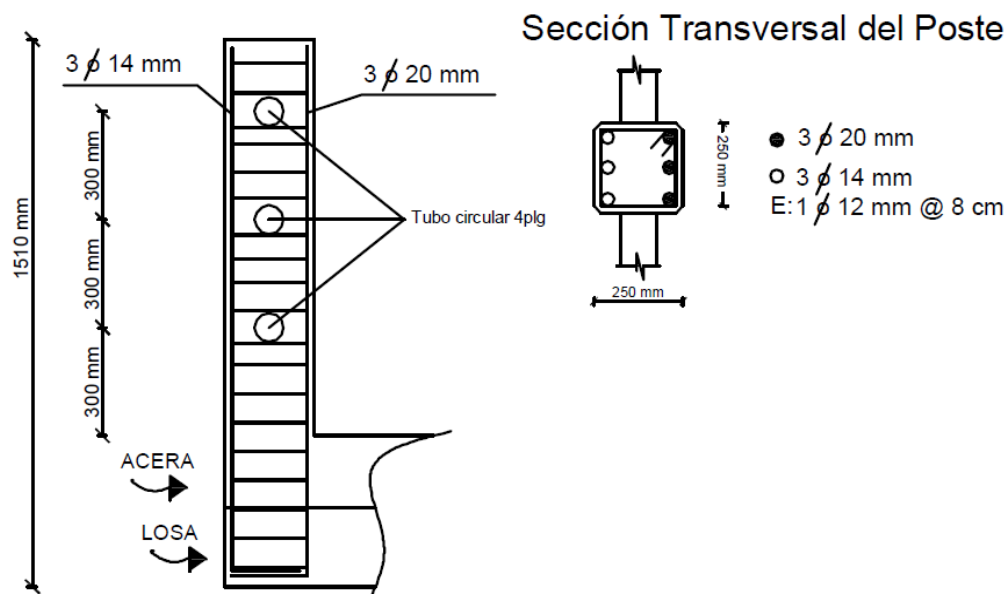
Armado de acero de la protección lateral. Elaborado por: Autor
